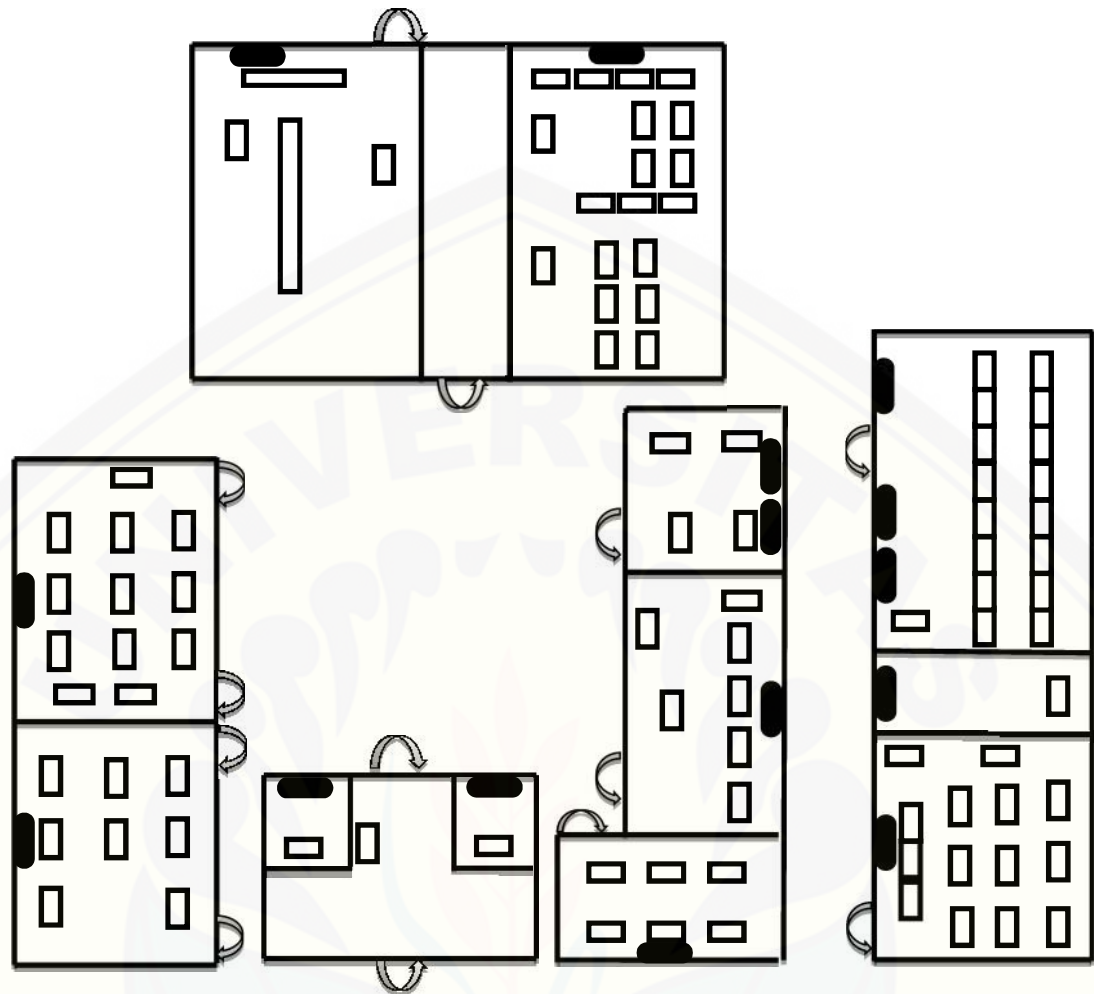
Denah Ruang Kantor Kelurahan Antirogo
